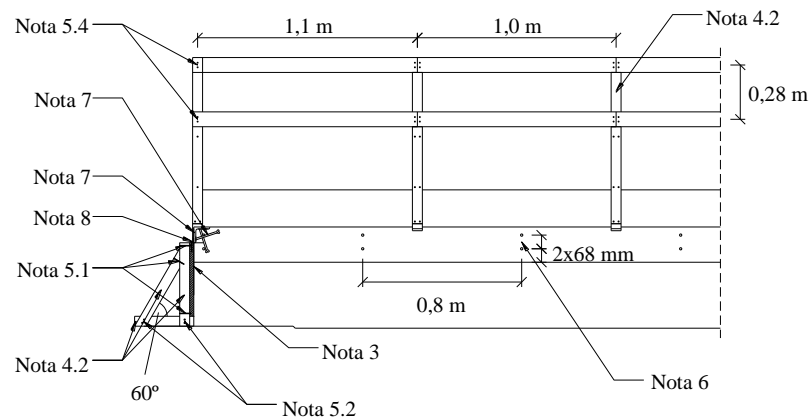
Secção longitudinal do escoramento e cofragem (secção AA).
